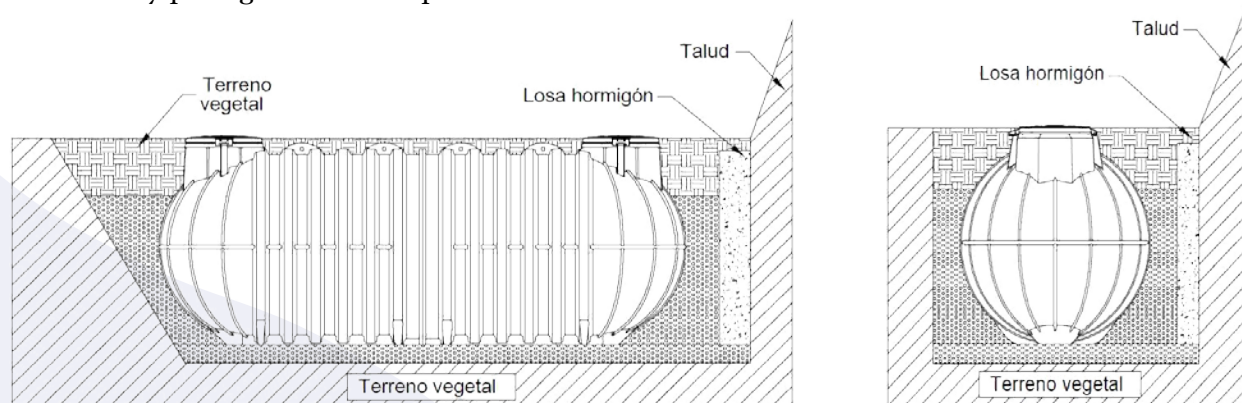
Ilustración VIII: Colocación de losa de hormigón vertical en terrenos inclinados.
